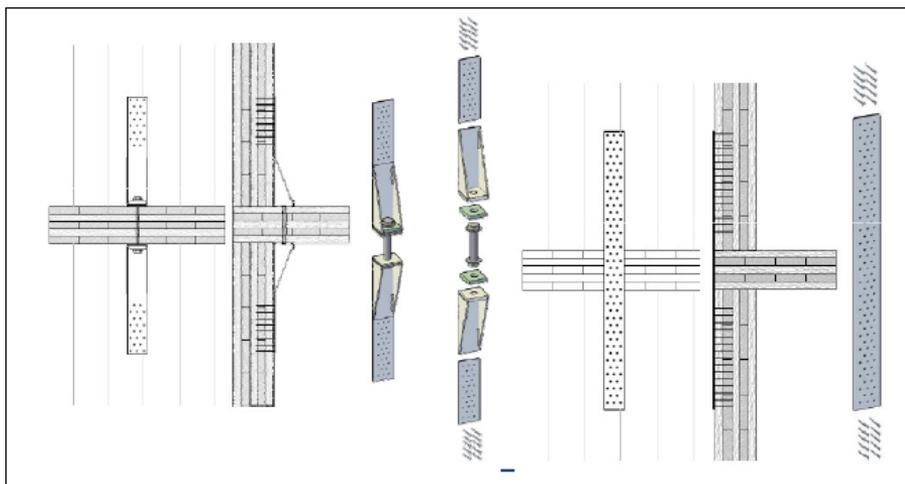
Elementi di collegamento parete-solaio-parete.
